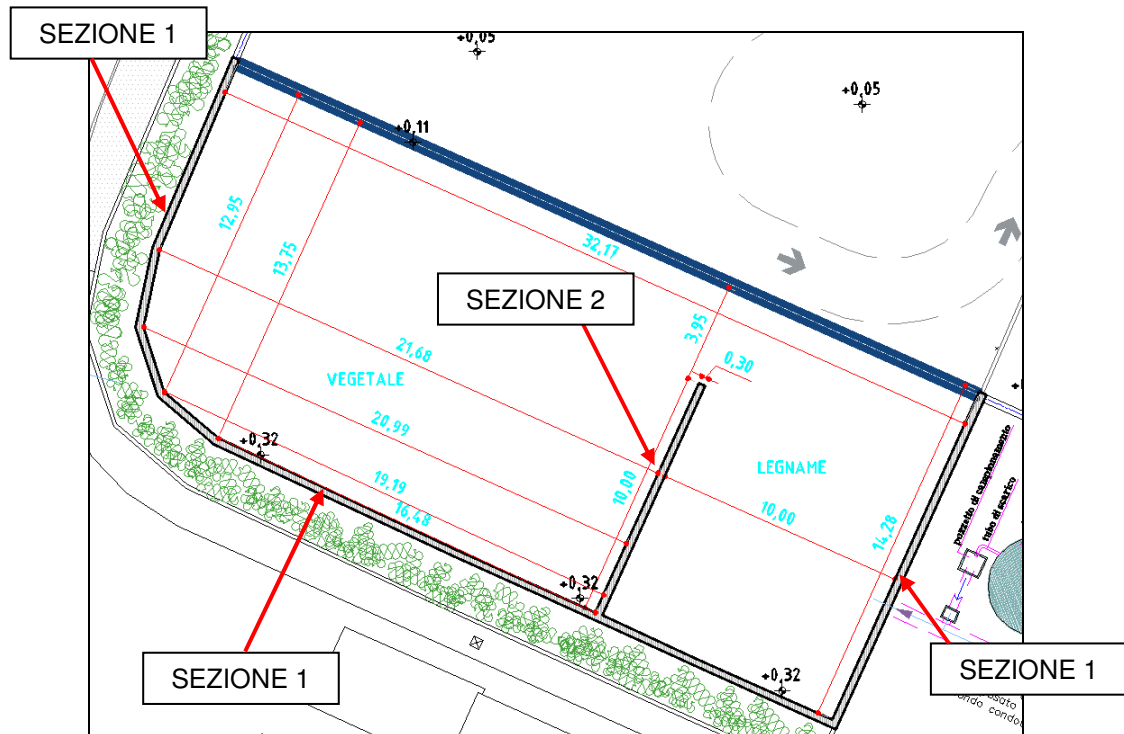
Planimetria e particolari costruttivi muro di contenimento di progetto
